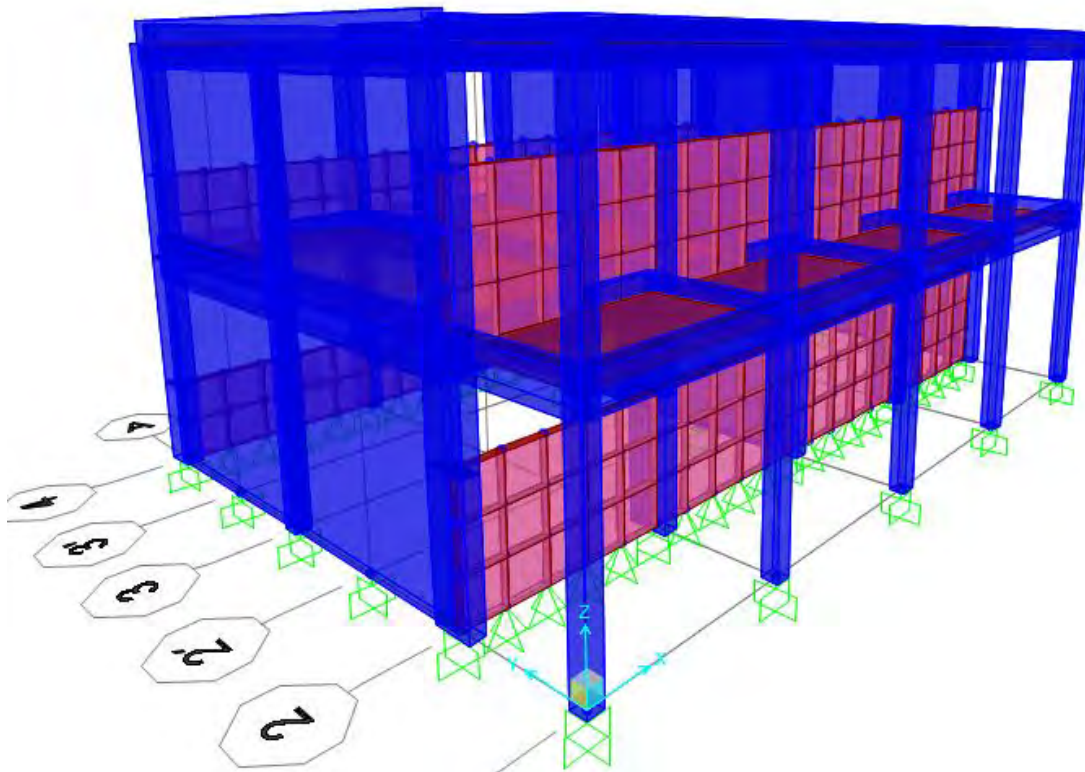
Vista en 3D de la primera tipología con enfoque hacia la fachada delantera.
